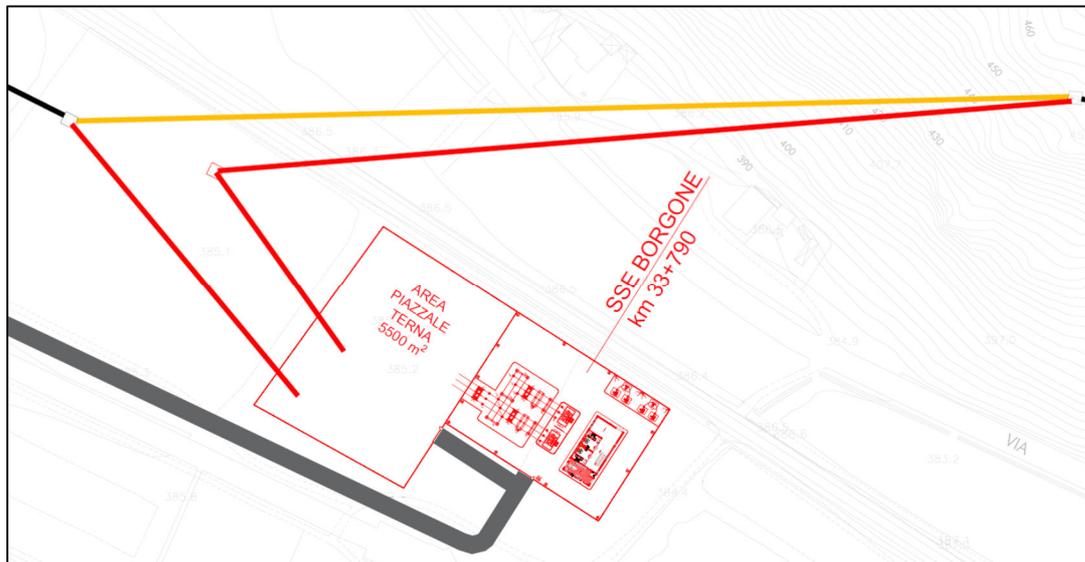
Stralcio planimetrico della Linea Primaria di alimentazione della SSE di Borgone
